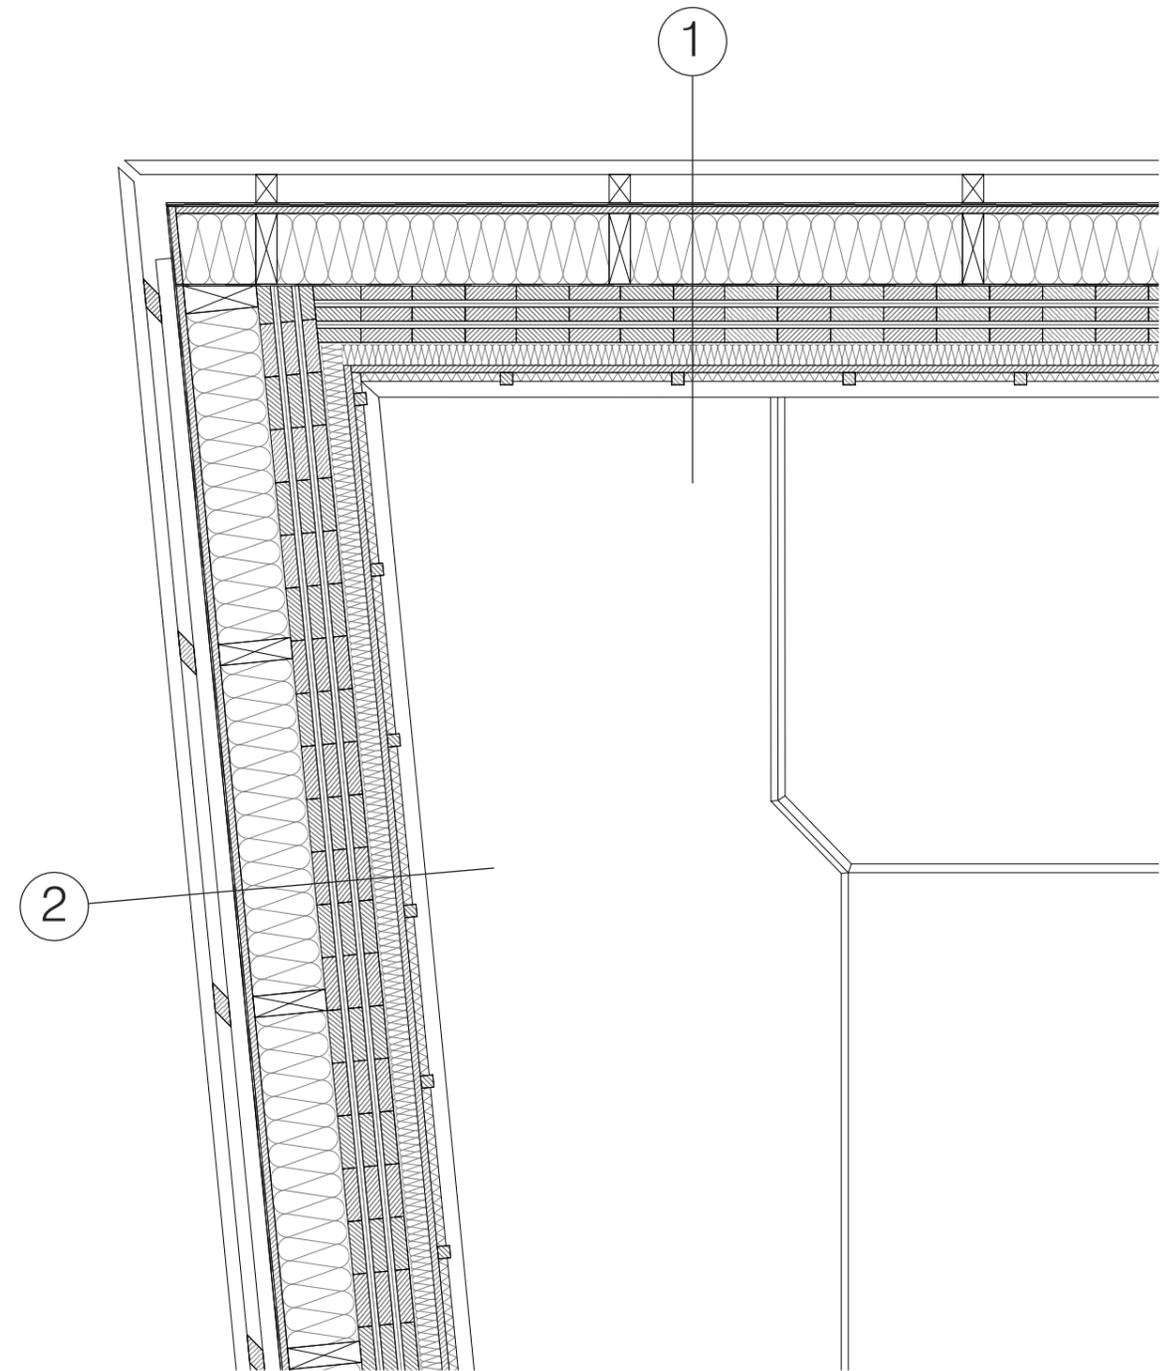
Fassadenschnitt 1 Dachdetail 1:20
